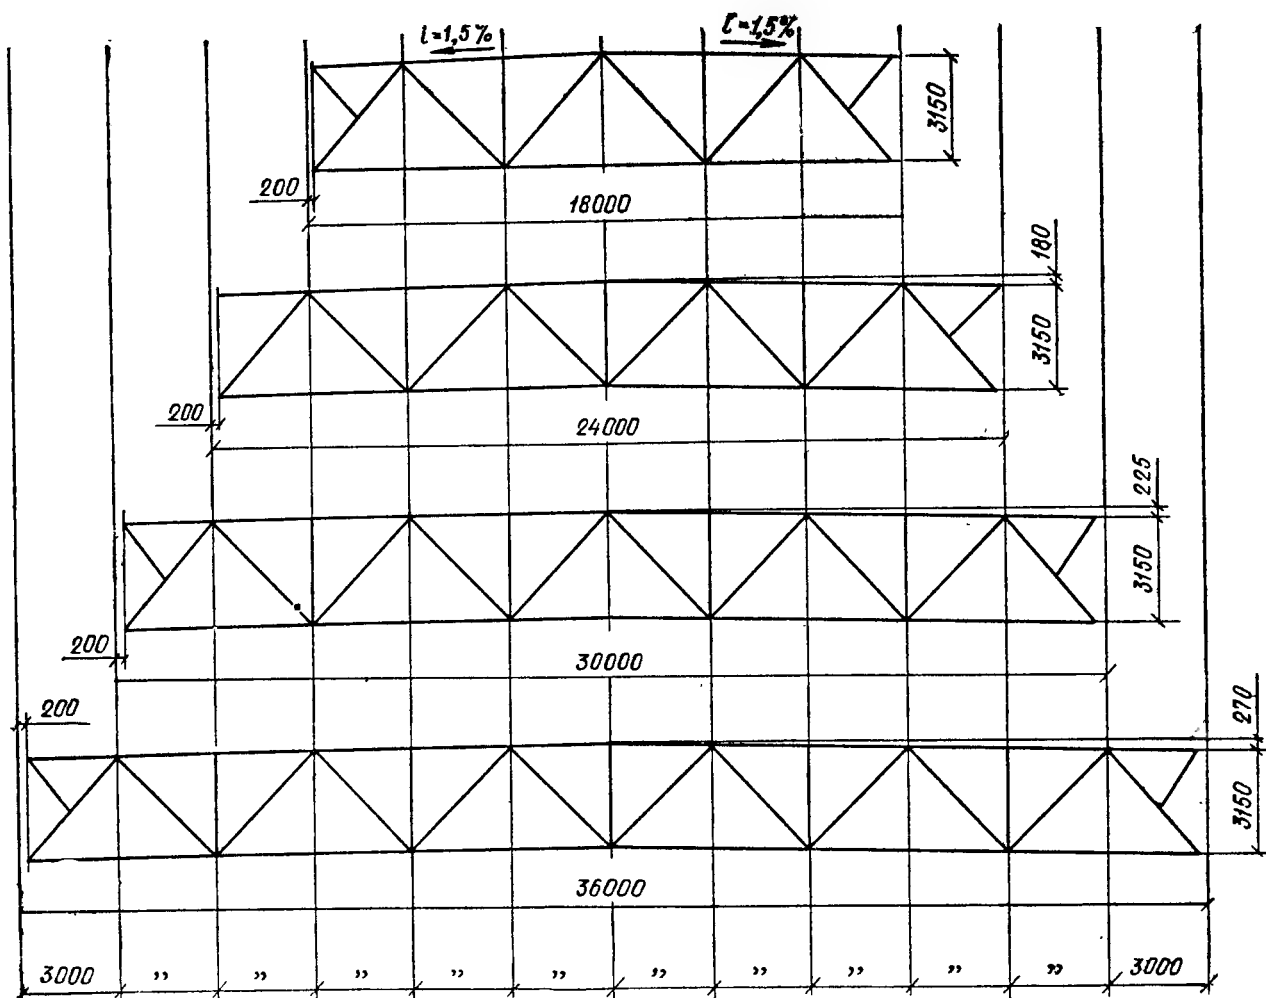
Схемы стропильных ферм (высота 3150 мм измеряется по обухам поясных уголков)
